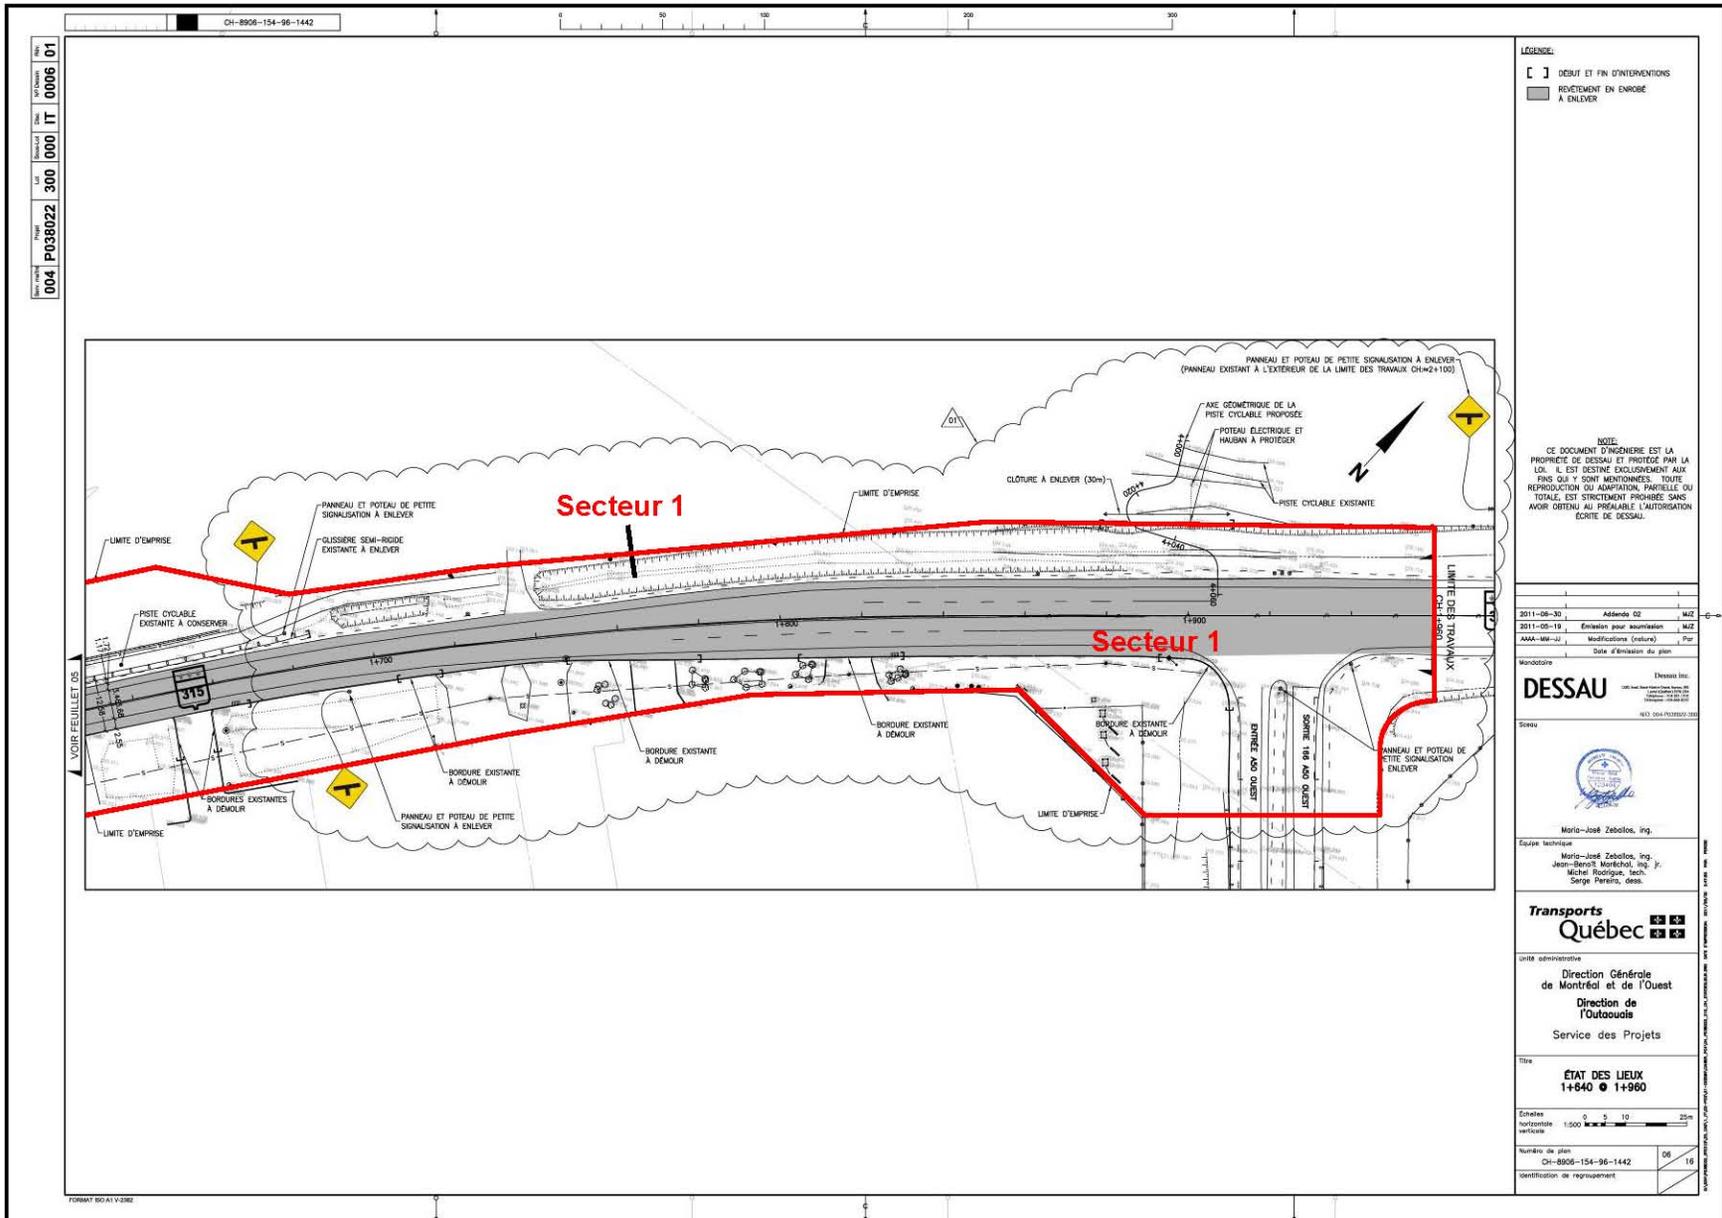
Localisation du secteur inventorié 1, projet n° 154-96-1442 (source : Ministère des Transports, plan d'ensemble [extrait], Plan d'ensemble – Travaux projetés, plan CH 8906-154-96-1442 (4/16), 30 juin 2011)
